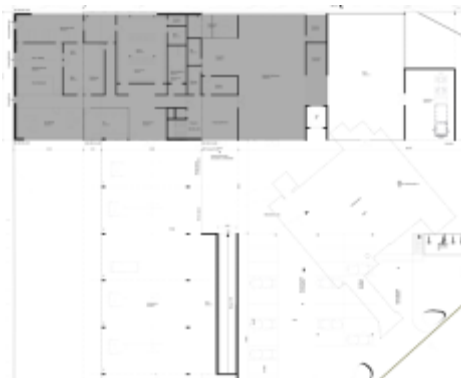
Grundriss Erdgeschoss, graue Fläche Büro
